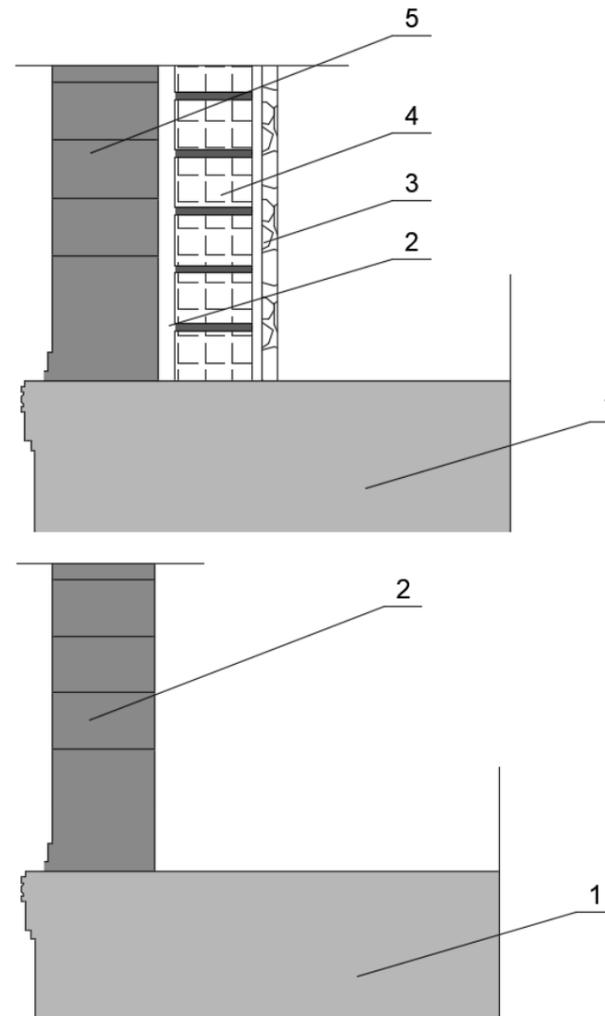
Estación Central de Amberes. Recreaciones muro fachada. Fuente: Propia. Escala: 1:20.
